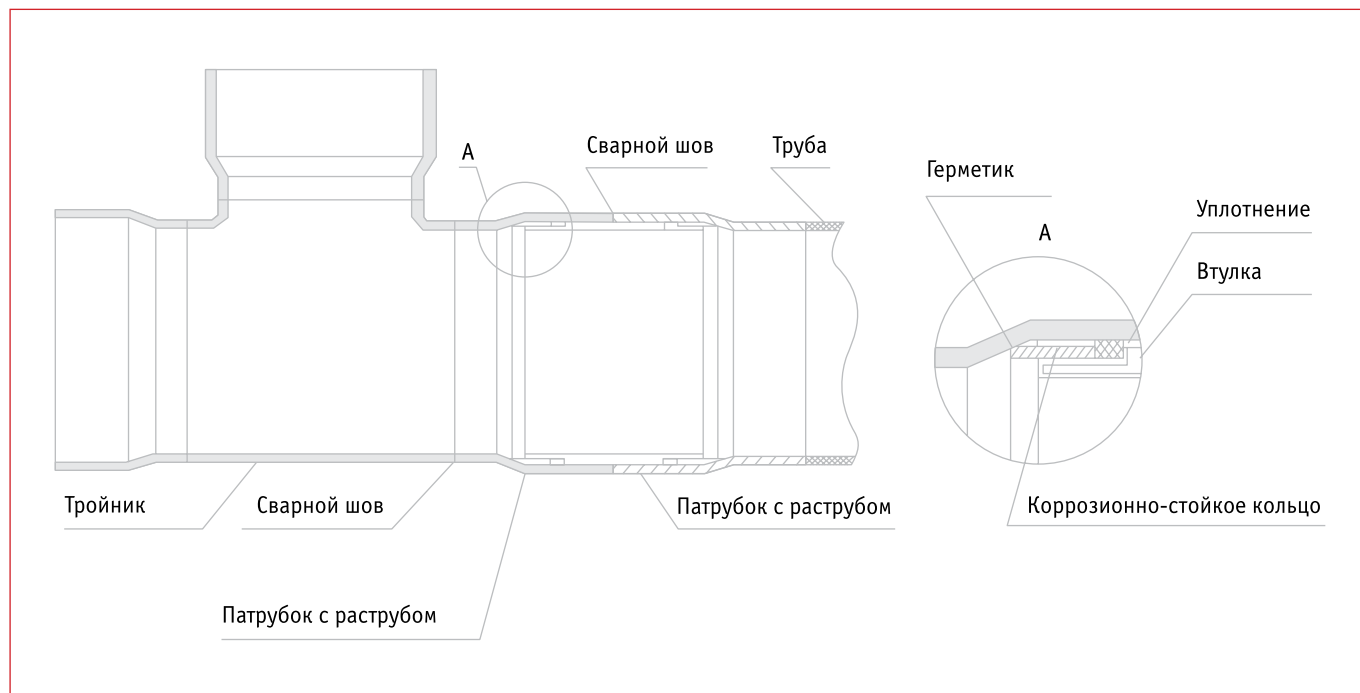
Внутренняя противокоррозионная раструбно-втулочная изоляция сварных соединений стальных труб с фасонными изделиями трубопроводов с внутренним эпоксидным покрытием
